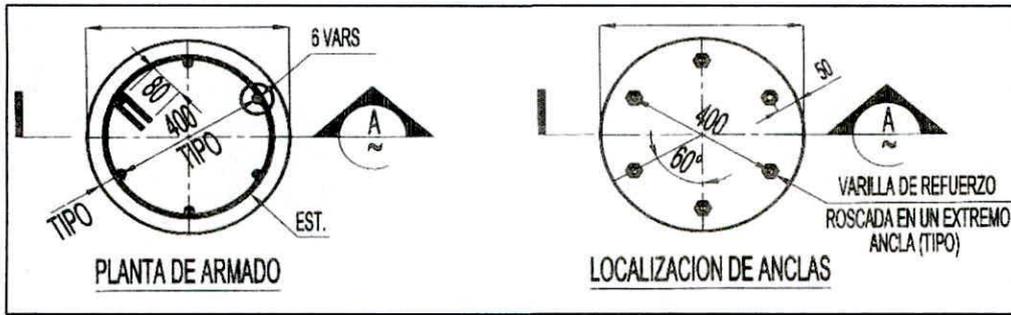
Planta de Cimentación y Anclas de poste de 9 a 11 metros
